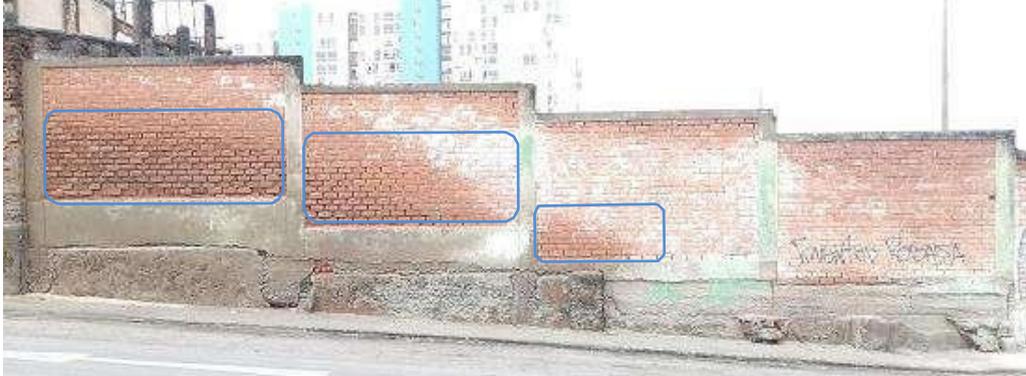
Muros de albañilería afectados por la patología eflorescencia en la unidad muestral 03.
